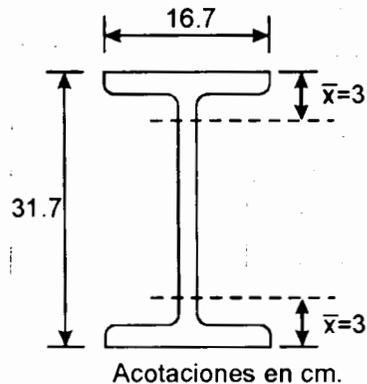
Elemento en tensión del ejemplo 1.5.
